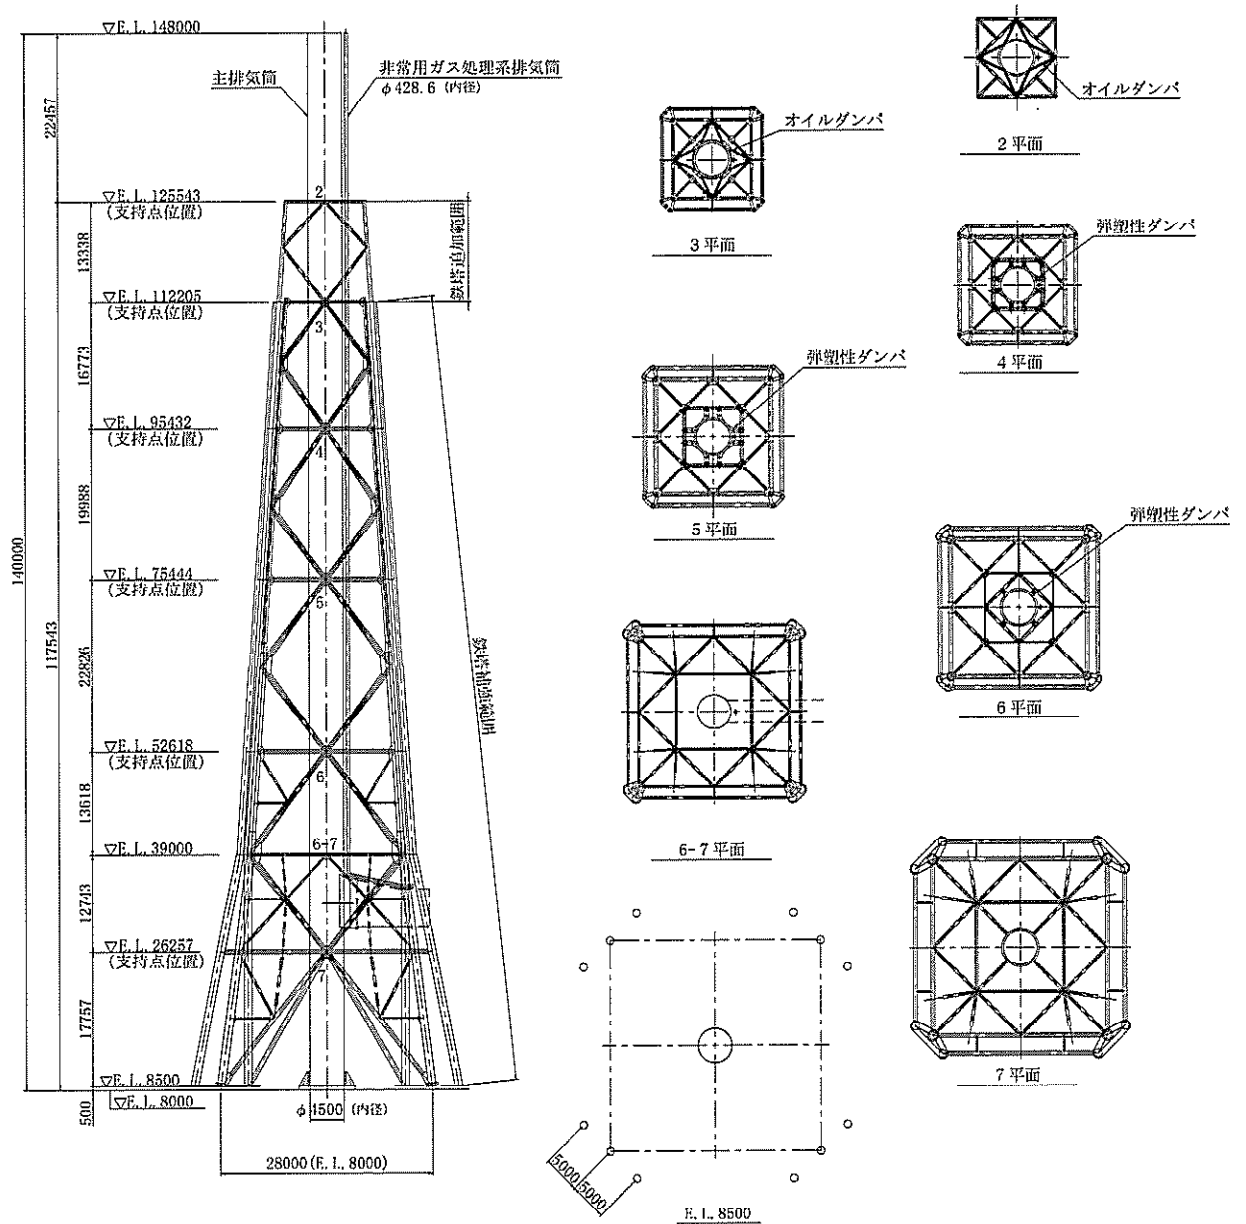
主排気筒の構造概要図 (単位 : mm)
